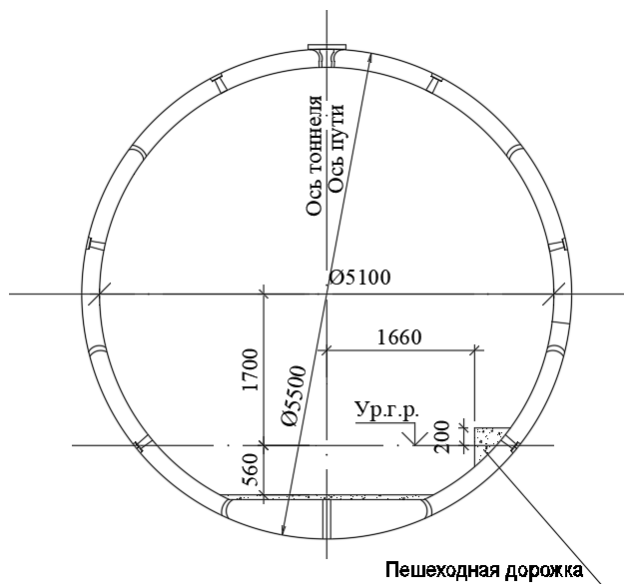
Обделка тоннеля из железобетонных сплошных блоков.
